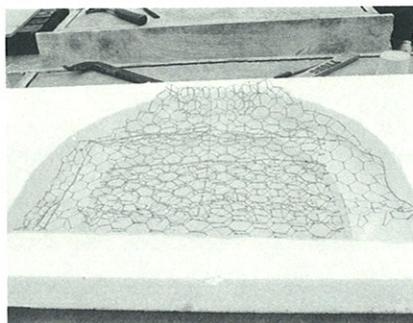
Die Styroporform für die Tür (vgl. Abb. 9) wird mit Hühnerdraht ausgelegt.
